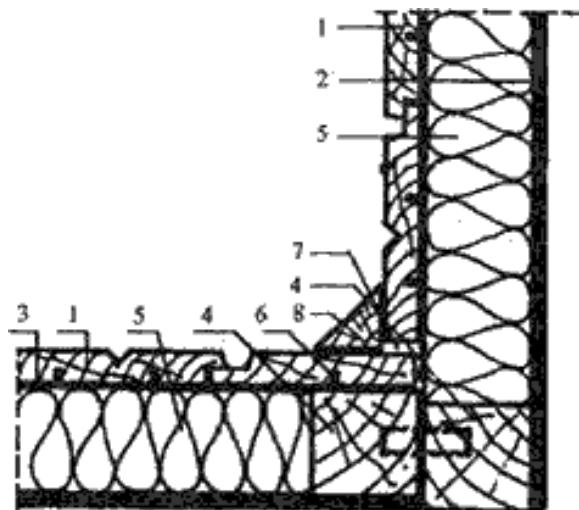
Угловое соединение щитовых стеновых элементов: 1 — угловая стойка; 2 — стеновая панель; 3 — установочная рейка; 4 — накладной элемент; 5 — гвоздь или шурп; 6 — пленка/фольга (внахлестку); 7 — плинтус; 8 — теплоизоляция.
